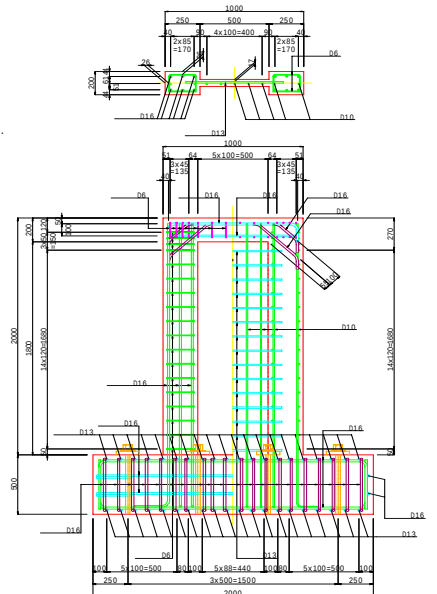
供試体載荷図 図 - 1 供試体配筋図例 (単位:mm)
